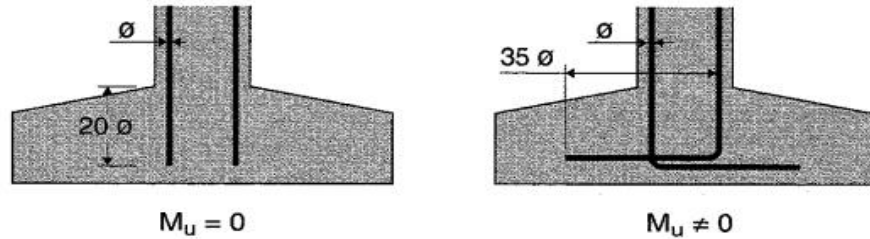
DIMENSIONS MINIMALES D'UNE SEMELLE SUPERFICIELLE
